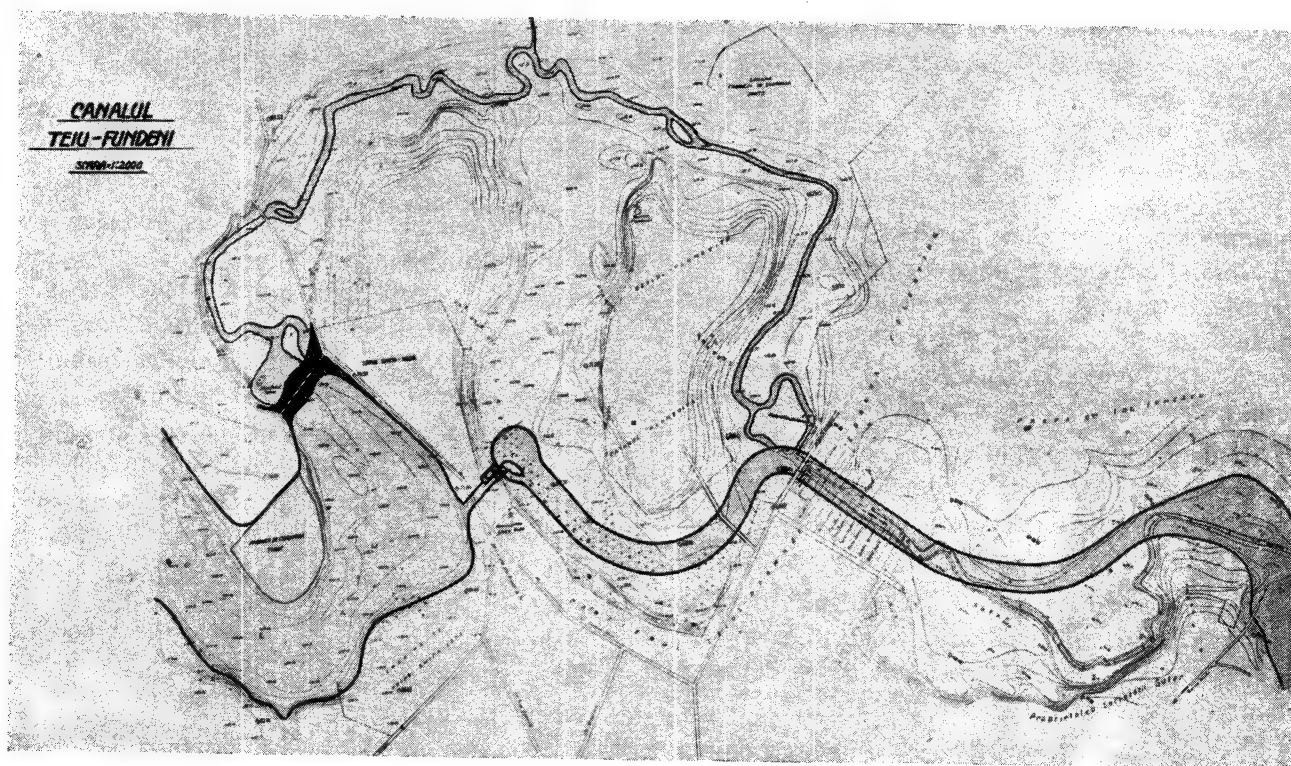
Plan de situație al canalului Tei-Fundeni.
